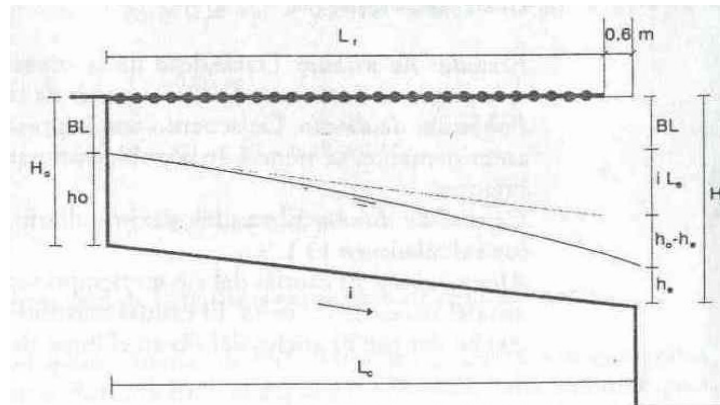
Perfil del canal de aducción (López Cualla, 1995)
